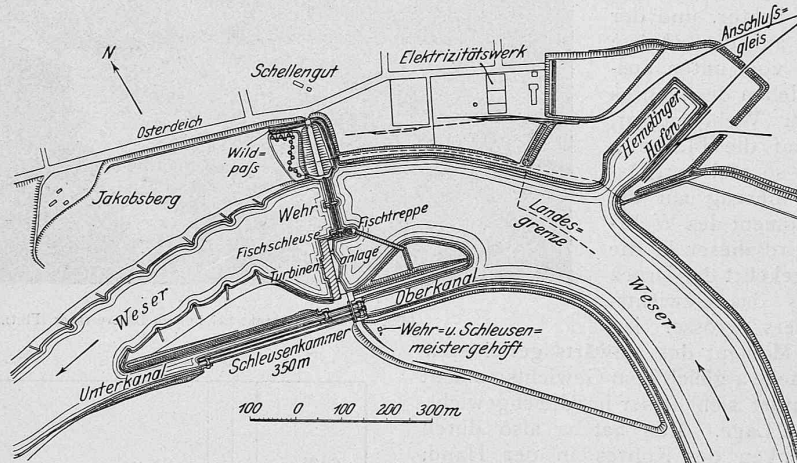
Lageplan des Weserwehrs bei Bremen. — Masstab 1:15000.
